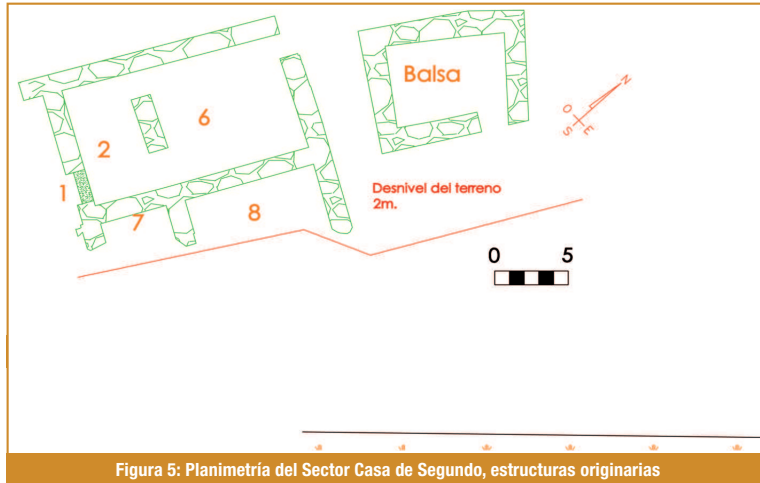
Planimetría del Sector Casa de Segundo, estructuras originarias
